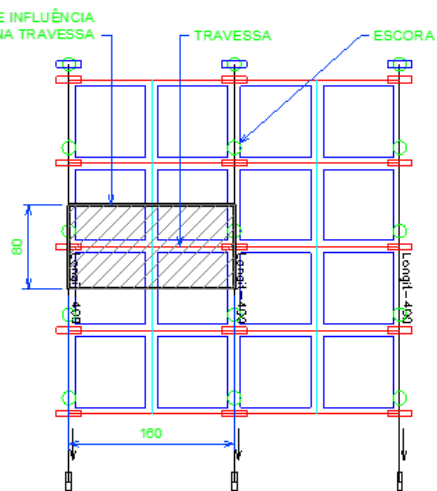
Planta típica de escoramento metálico com a identificação da área de influência considerada em cálculo
